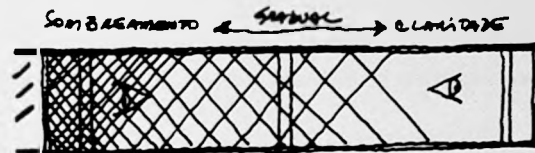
Croqui corte transversal de um pavimento tipo do MESP.
